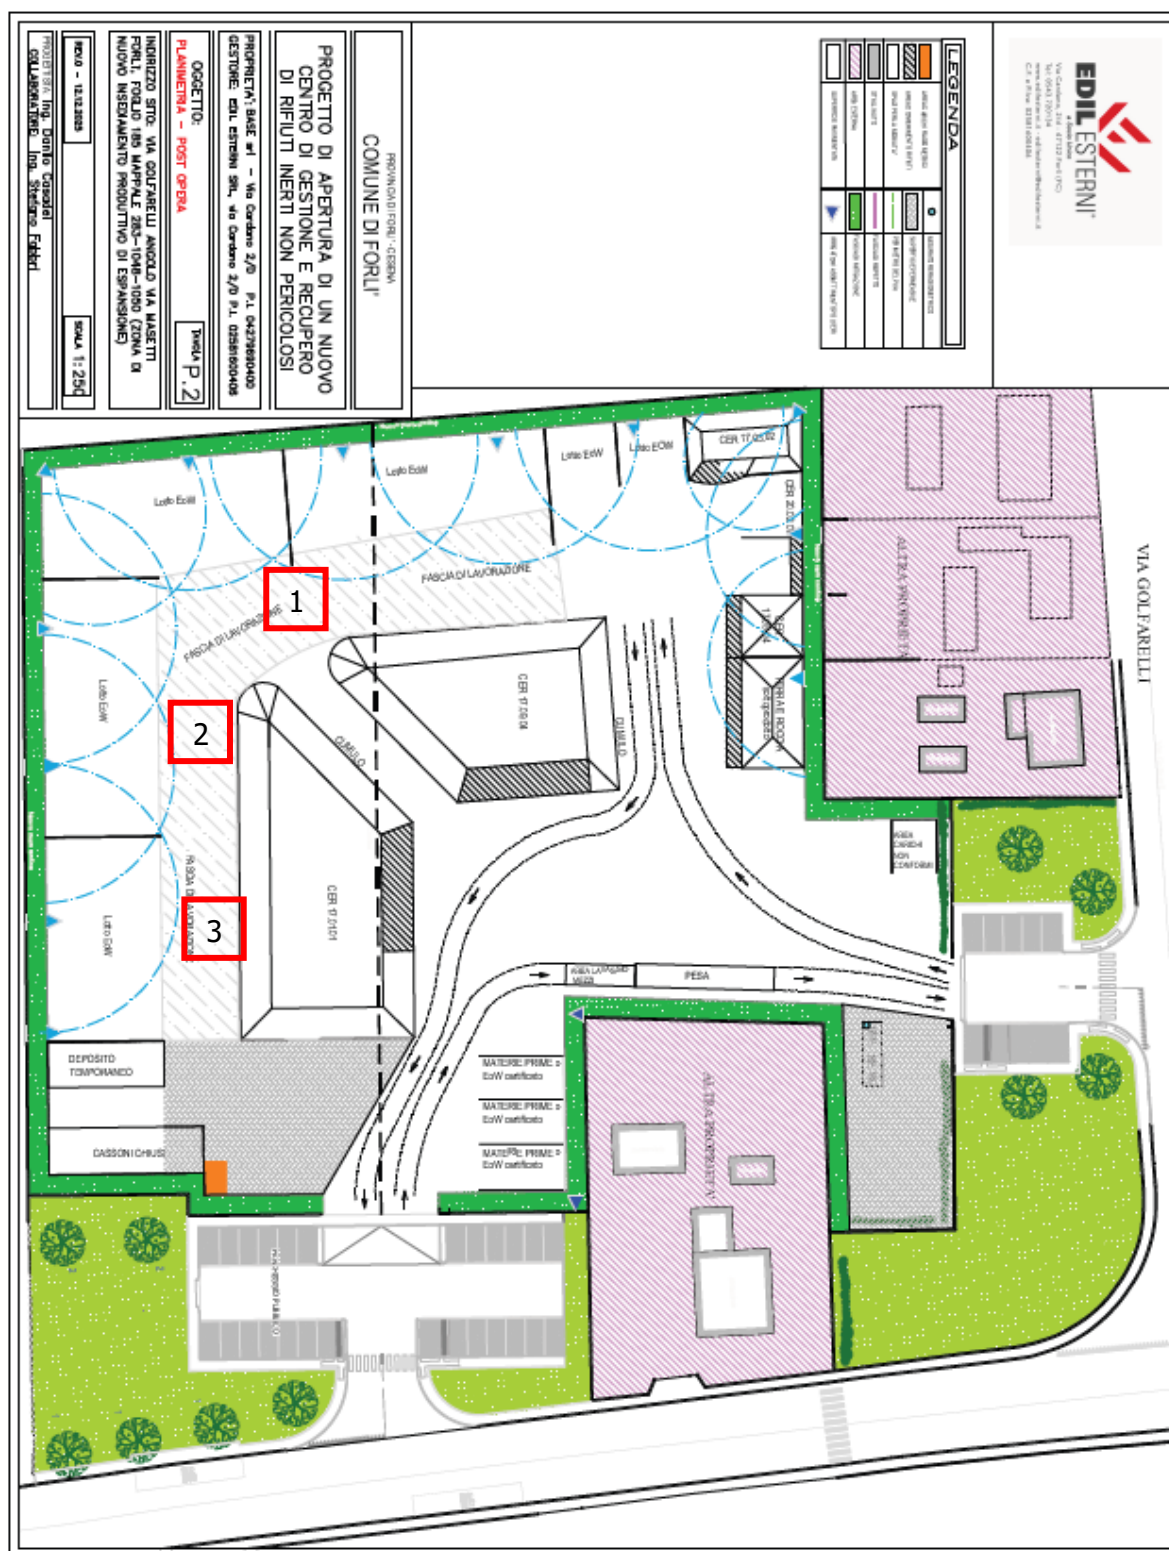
02 Planimetria impianto, stato POST-OPERAM
